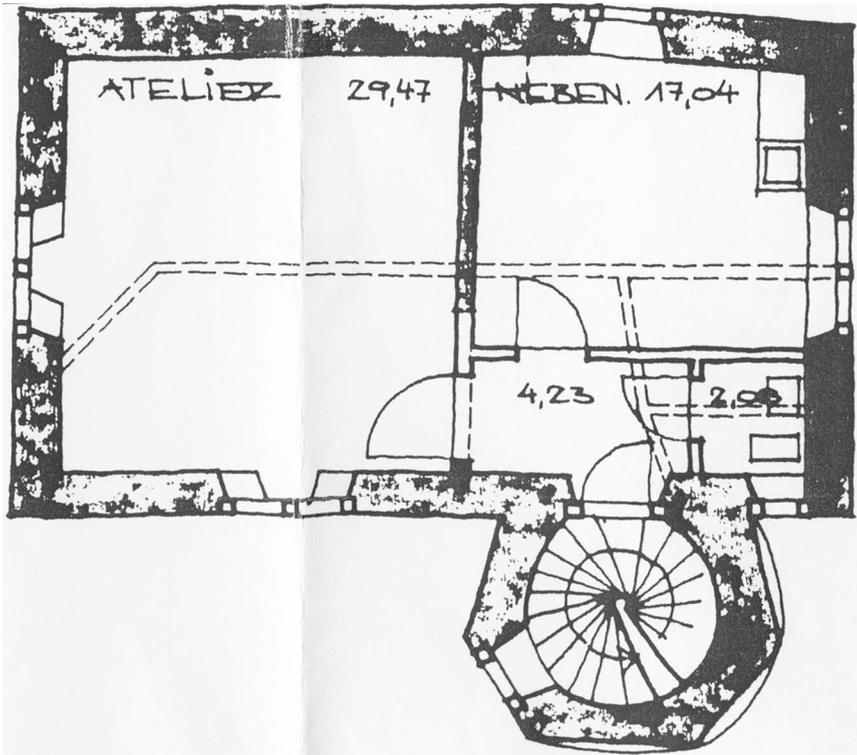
Meierhof Stetten, Grundriss des 1. OG (Norden ist rechts)
